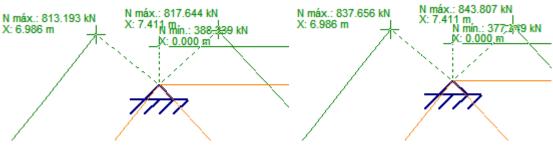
| Unión N° 4 Reticulado Norte – Sur.
